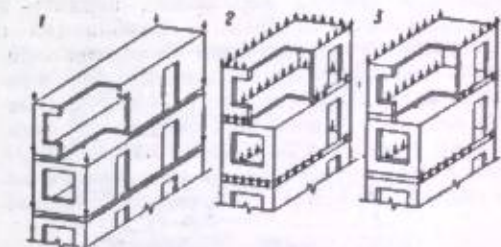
Схема опирания объемных блоков: 1 — по углам; 2 — по периметру; 3 — по продольным стенам.
